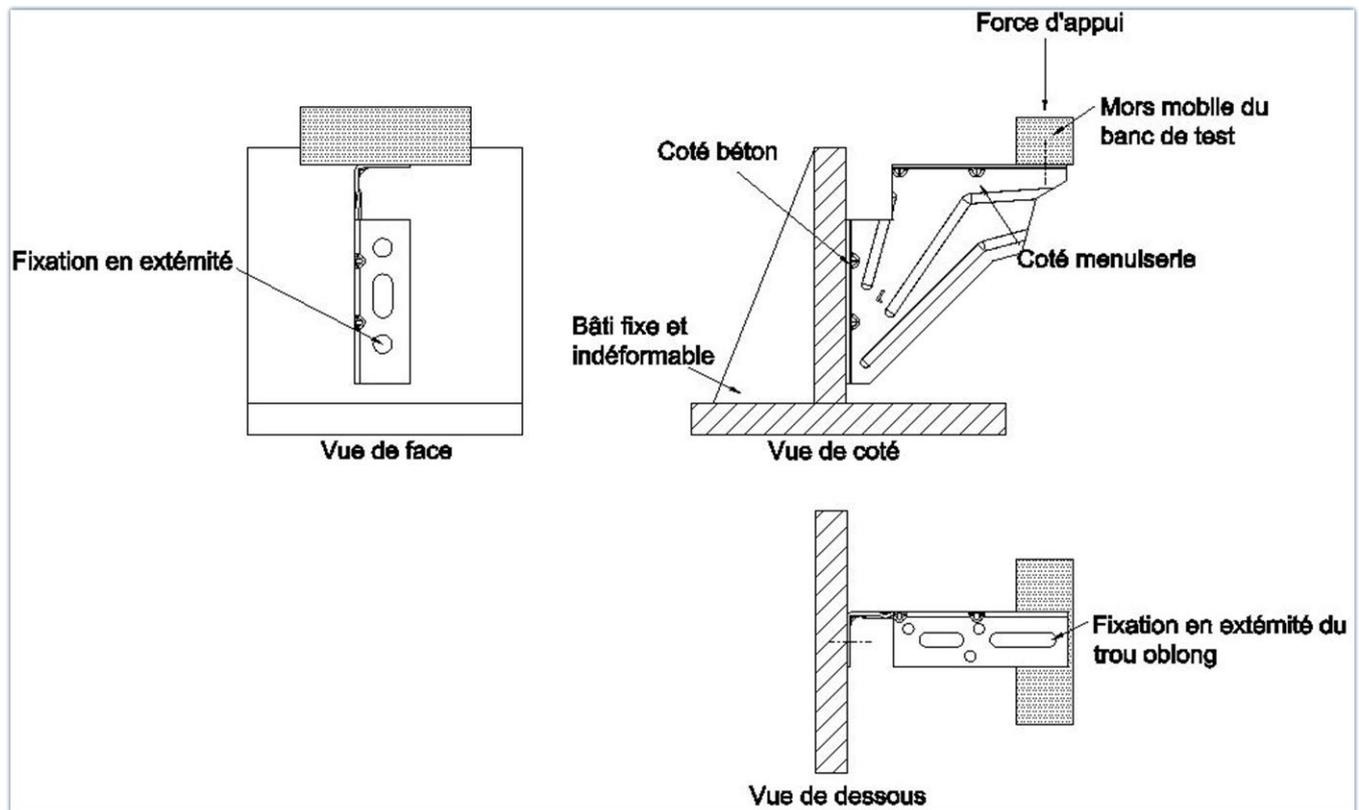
Schéma du montage pour l'essai en flexion de pattes de fixation : cas d'une patte à gousset
